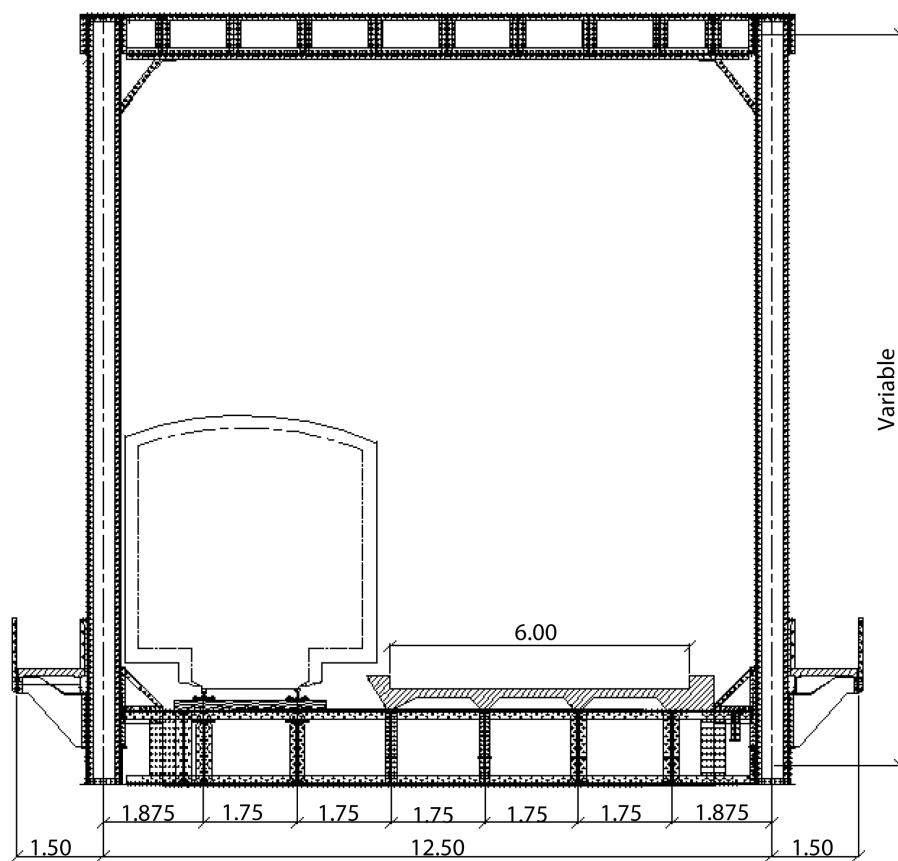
b : Coupe transversale du pont-rails de Marazeek.
